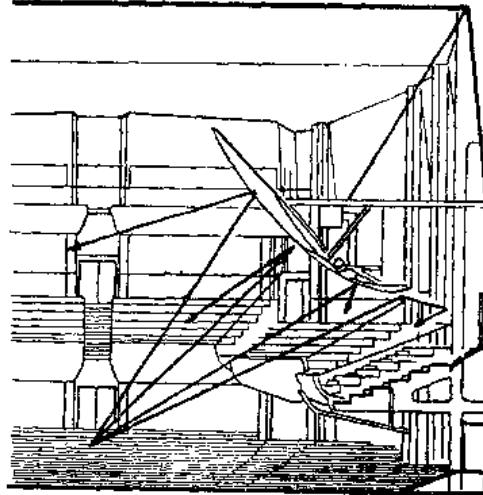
惠灵顿 (Wellington Town Hall) 音乐厅剖面
